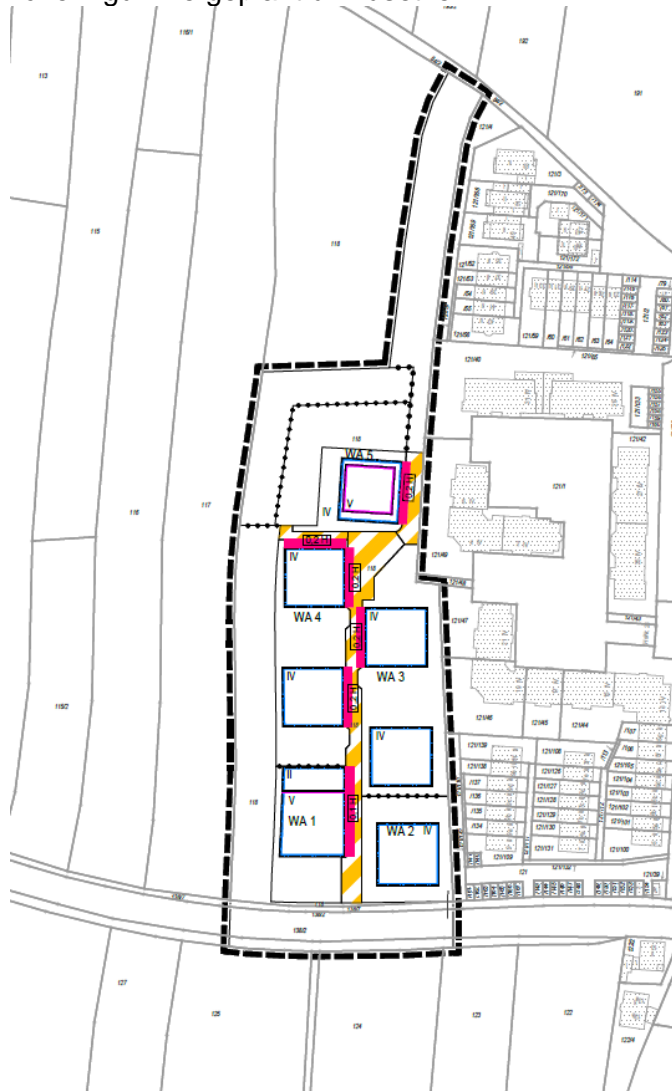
Beiplan Abstandsflächen zum BP Nr. 4673
